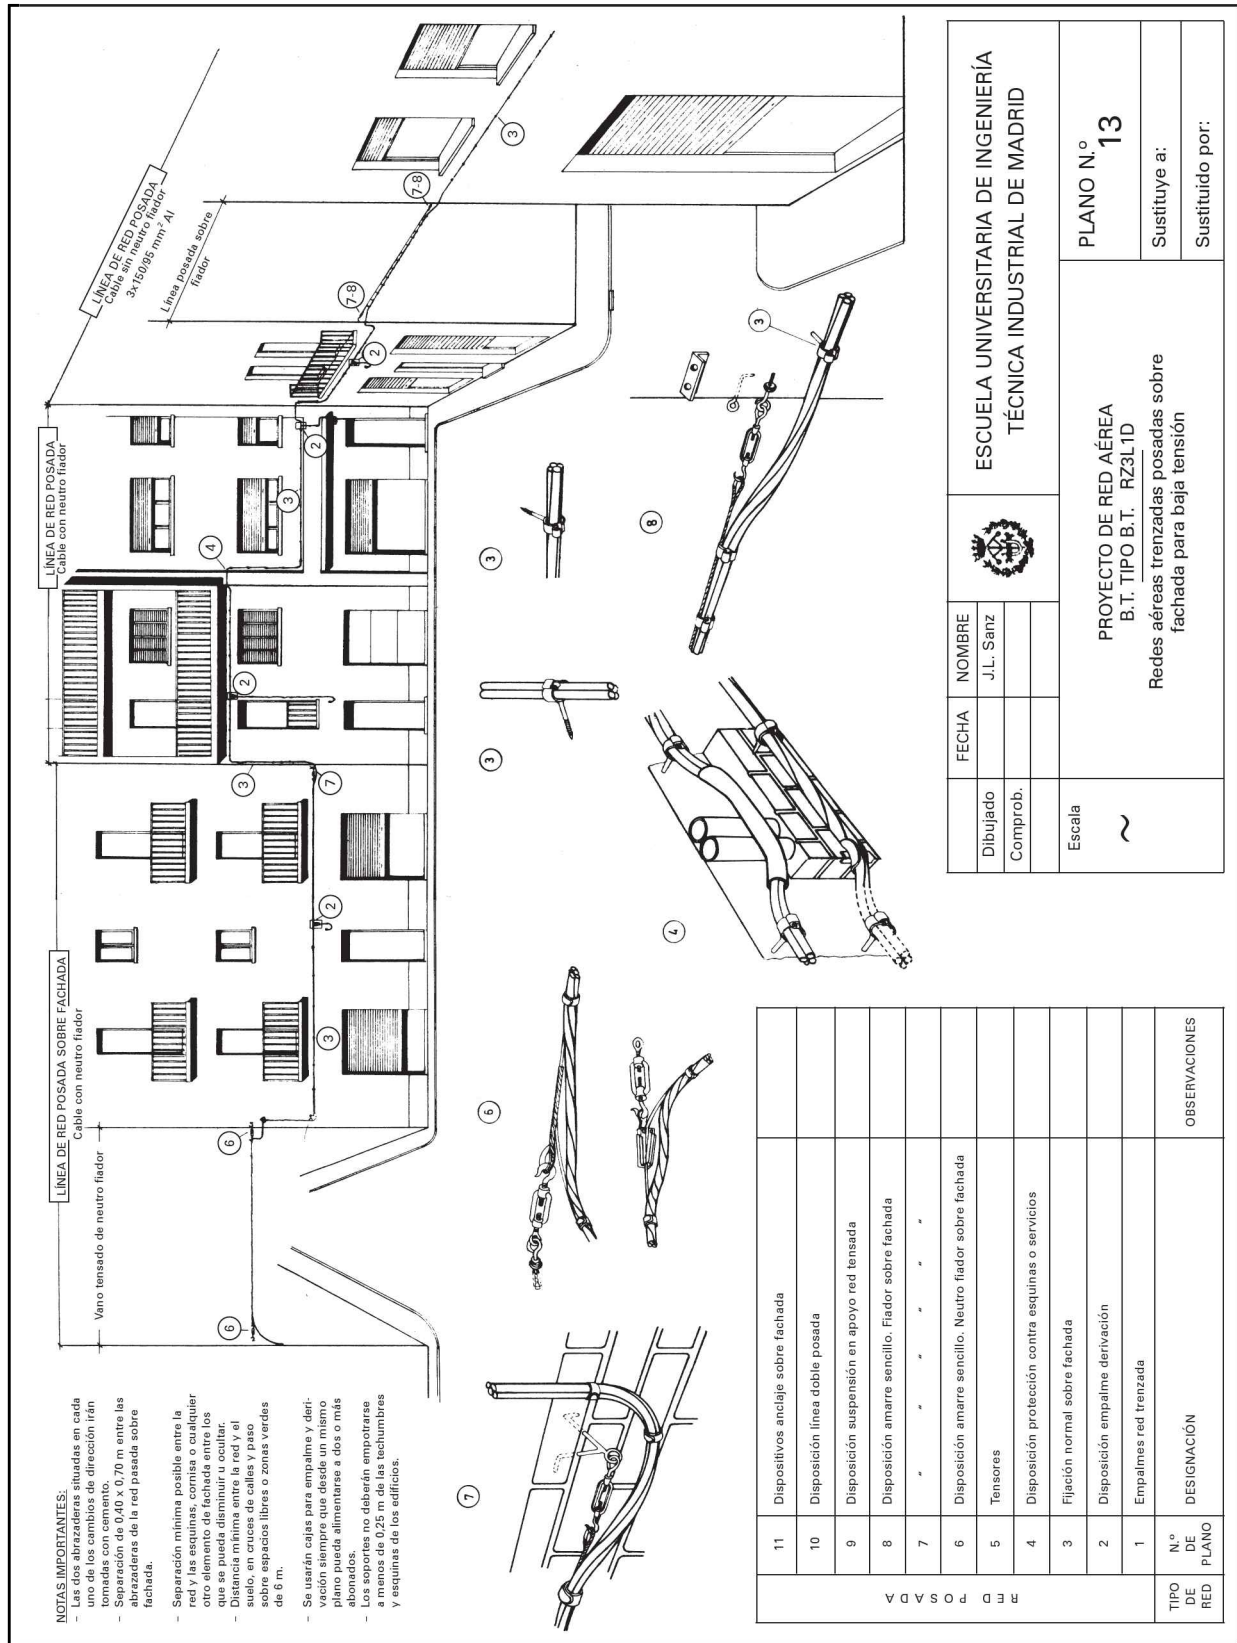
Redes aéreas trenzadas posadas sobre fachadas para Baja Tensión.
